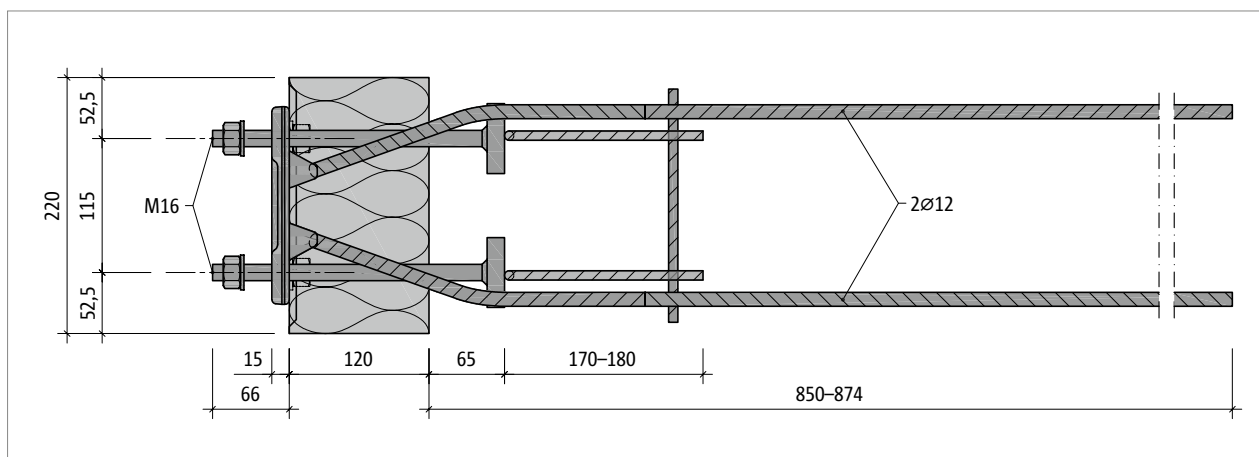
Schöck Isokorb® XT type SQ-V3 : vue en plan
